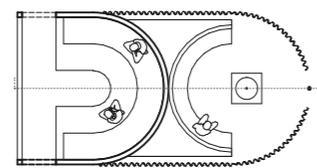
Meditation: Schnitt und Grundriss
